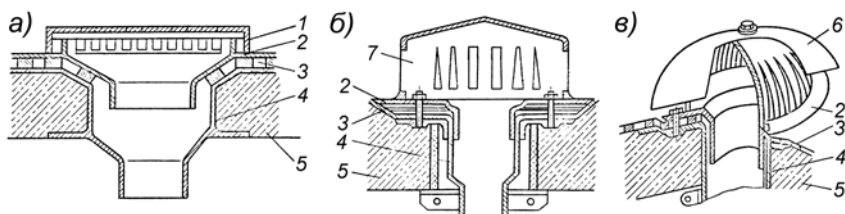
Водосточные воронки: 1 – решетка; 2 – рама; 3 – слой гидроизоляции; 4 – корпус; 5 – перекрытие; 6 – струевыпрямитель
